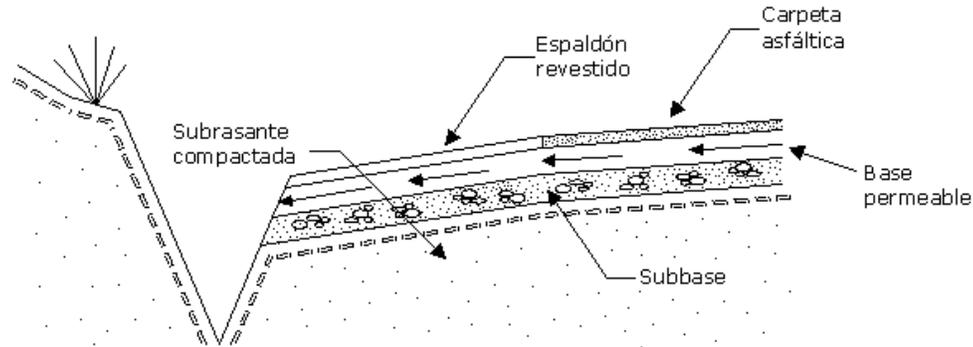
Corte transversal donde se muestran los componentes de una vía con pavimento asfáltico.
